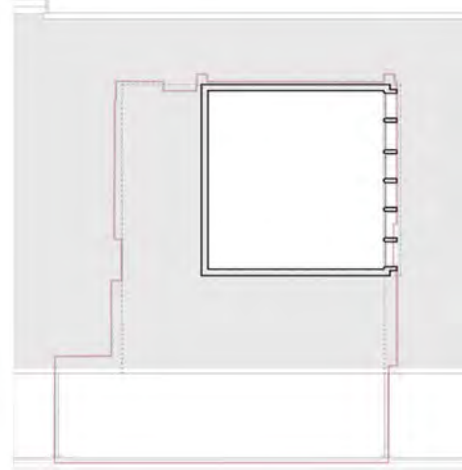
Planta do Volume Superior (1953), Configuração Original
